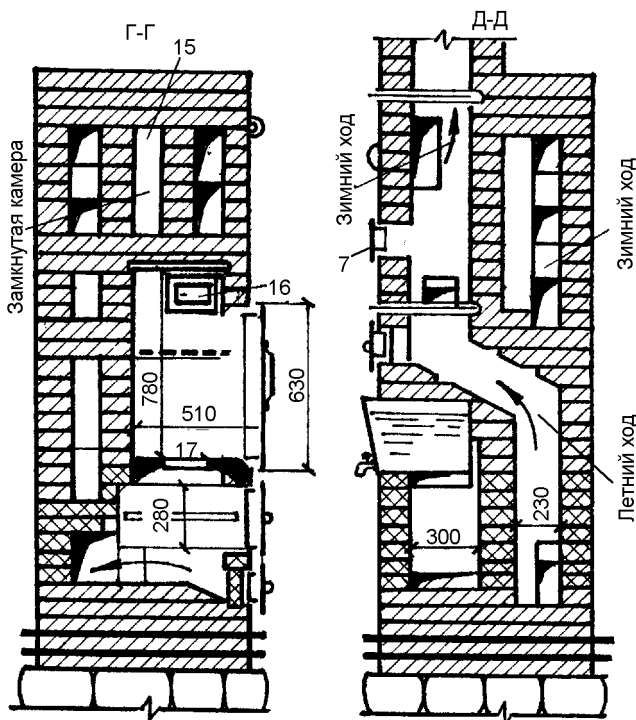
Устройство отопительно-варочной печи И. Ф. Волкова без камеры для выпечки хлеба
